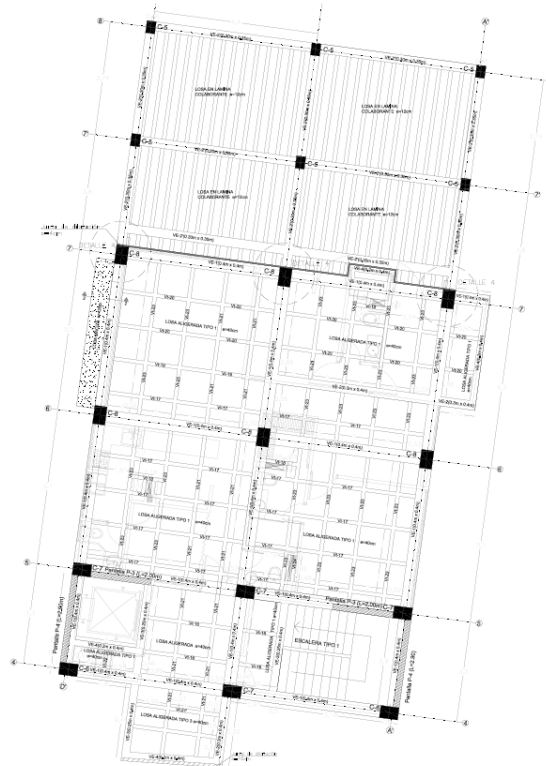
Planta de Entrepiso Bloque B Torre Típica.
